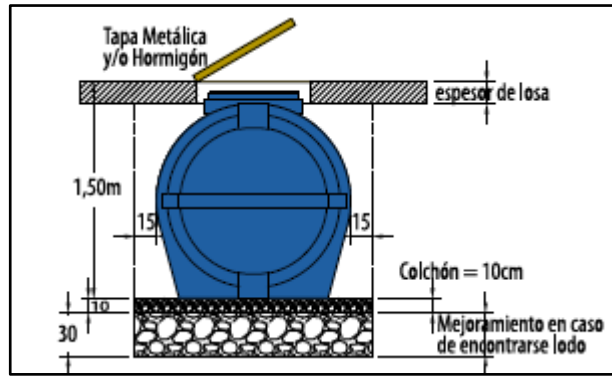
Instalación Estándar Tanque TITÁN – Vista en Corte
